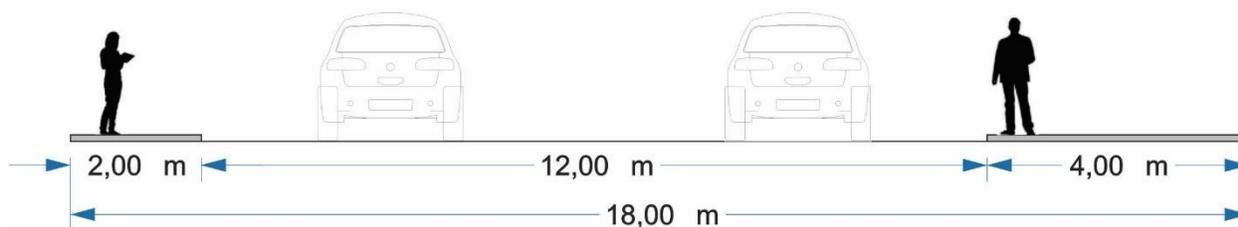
Levantamiento perfiles vialesFuente: (Elaboración propia, 2020)
